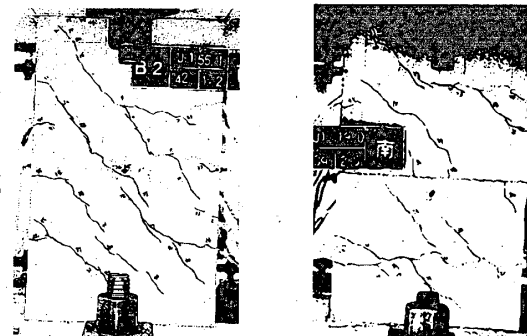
試験体2ひび割れ 試験体3ひび割れ
